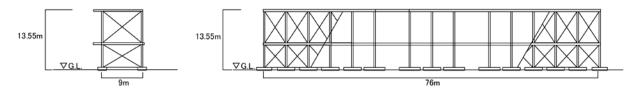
(4) 断面図(E 設備架台、G 設備架台)
